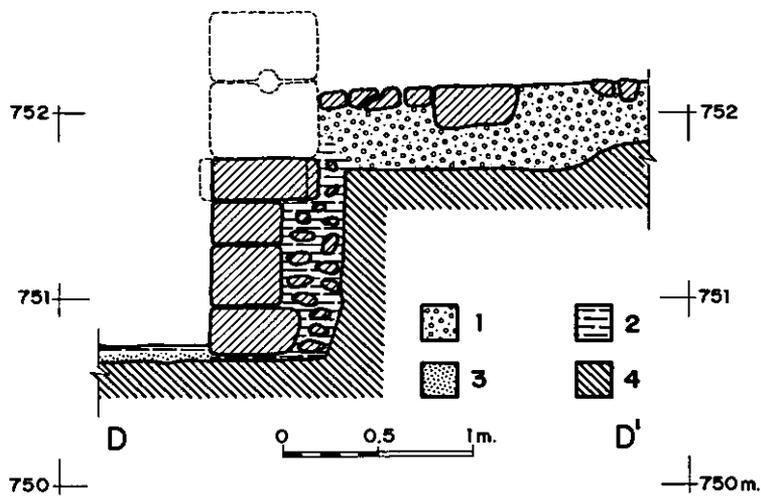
Reconstrucción teórica del estado originario del Estanque por la sección D-D' de las figuras 15 a 17 (para el significado de los signos véase la figura anterior).
